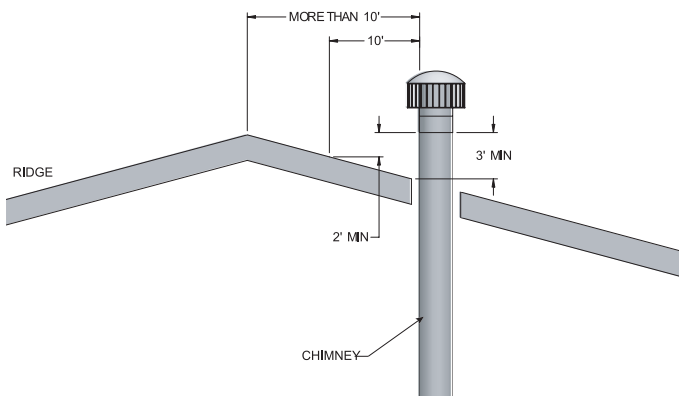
Terminaison de ventilation depuis un toit à double pente - à 10 pi. au minimum du bord
